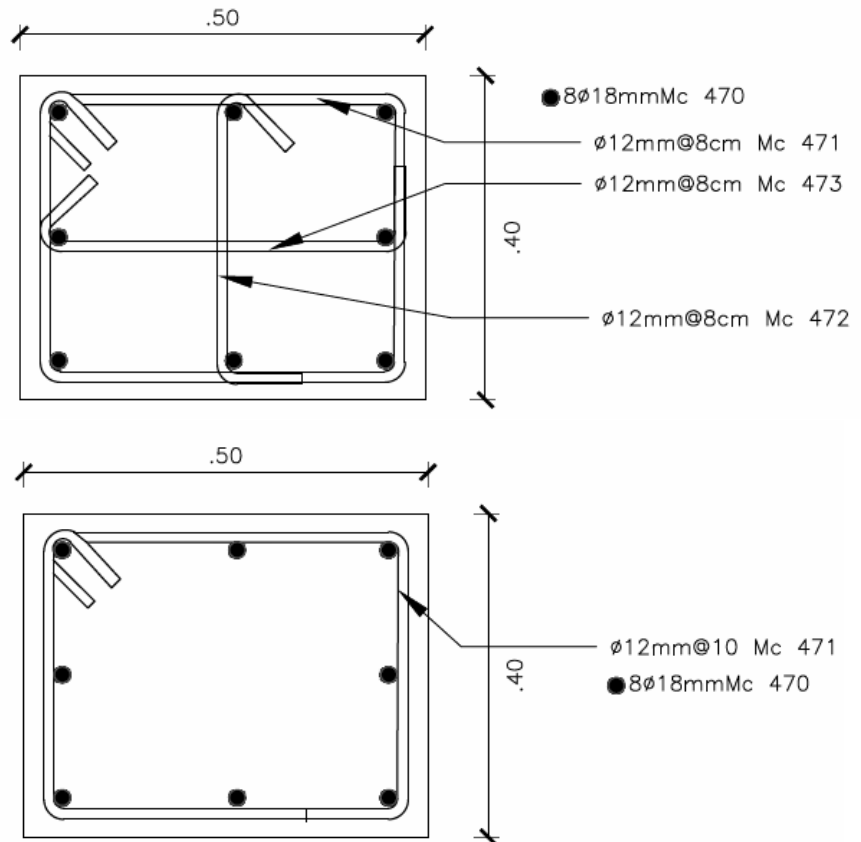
Columna Sección 40 cm x 50 cm, armado dentro de l_0 y fuera de l_0
